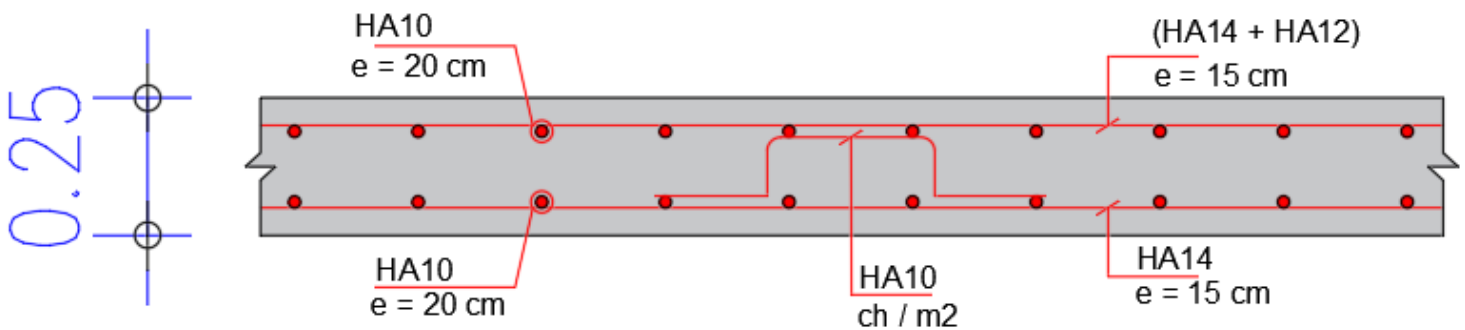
Ferrailage de la dalle (coupe transversale).
